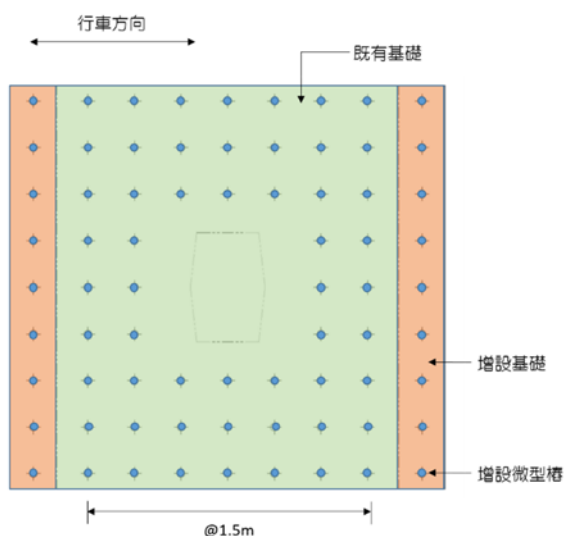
彰化一號高架橋 基礎增設微型樁補強 補強平面示意圖
